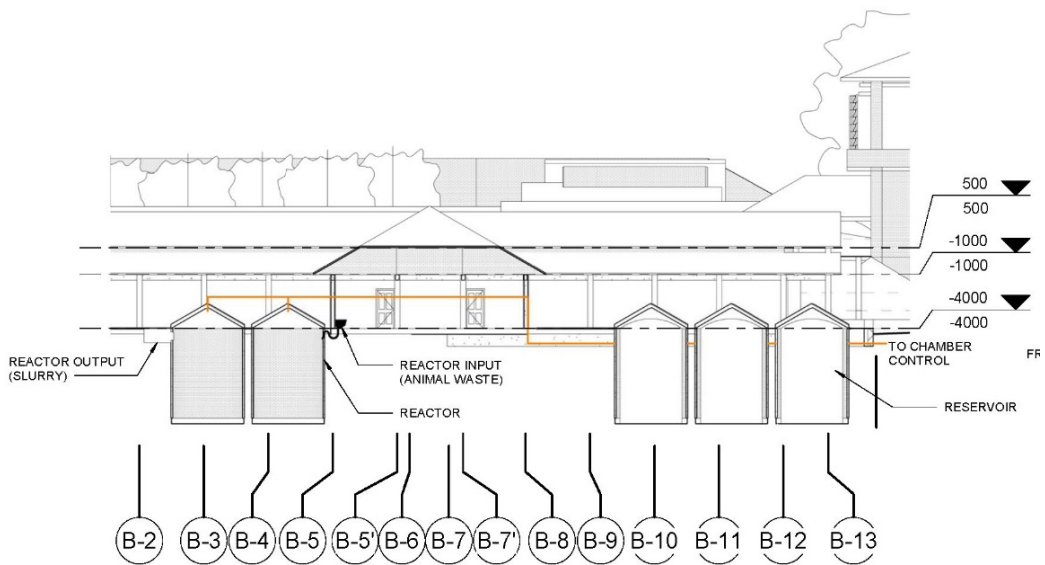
Teknis aplikasi rangka dan struktur bangunan
